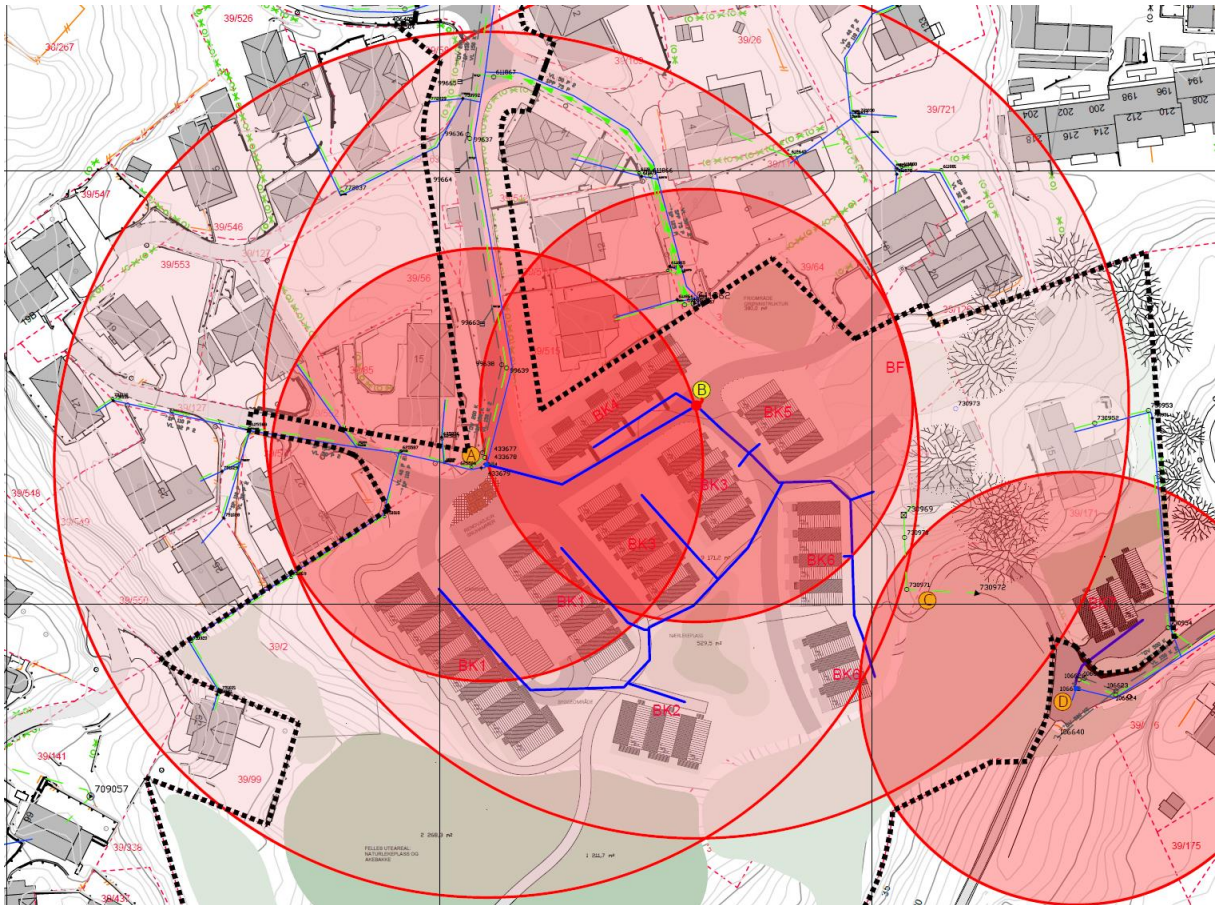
Utsnitt fra VA-rammeplan (2024)
